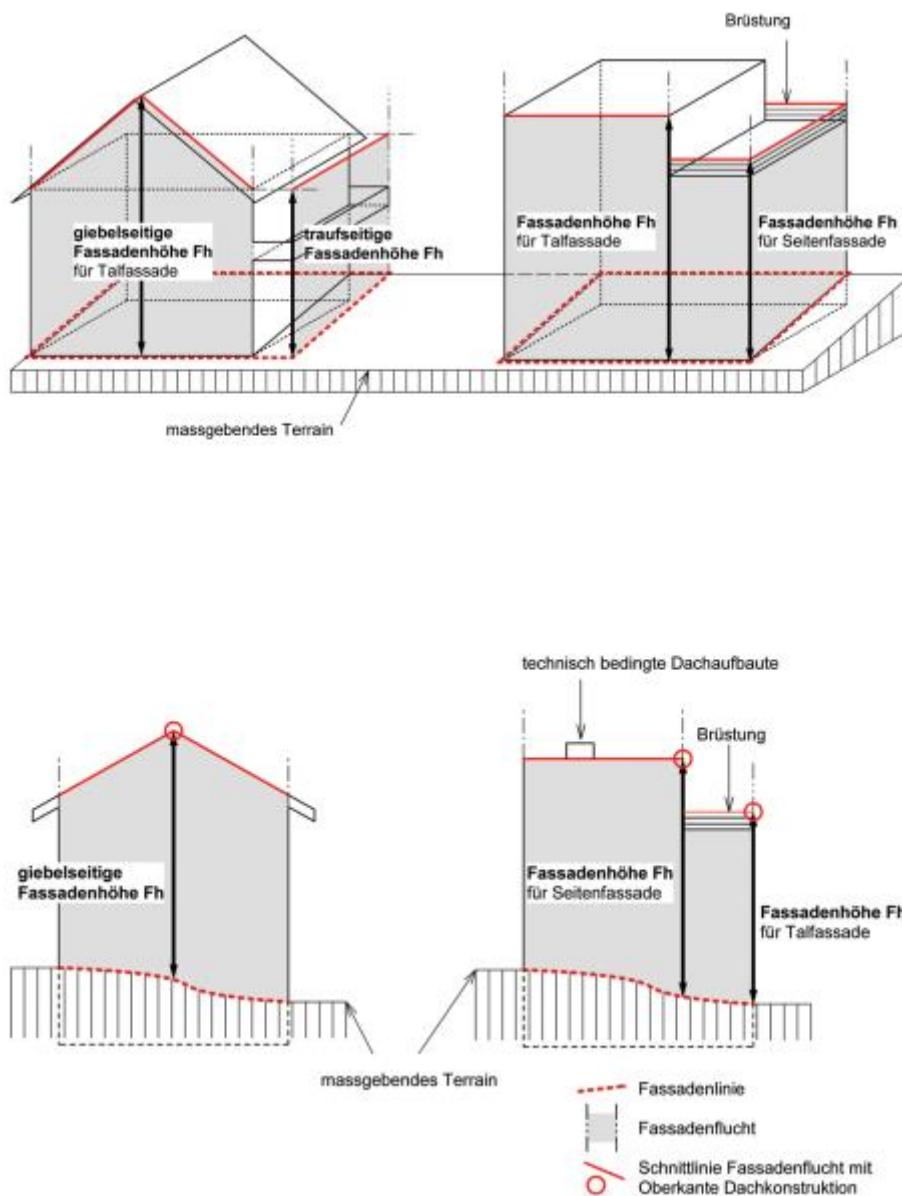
Figur 5.2 Fassadenhöhe (Anhang 2 BauV)
